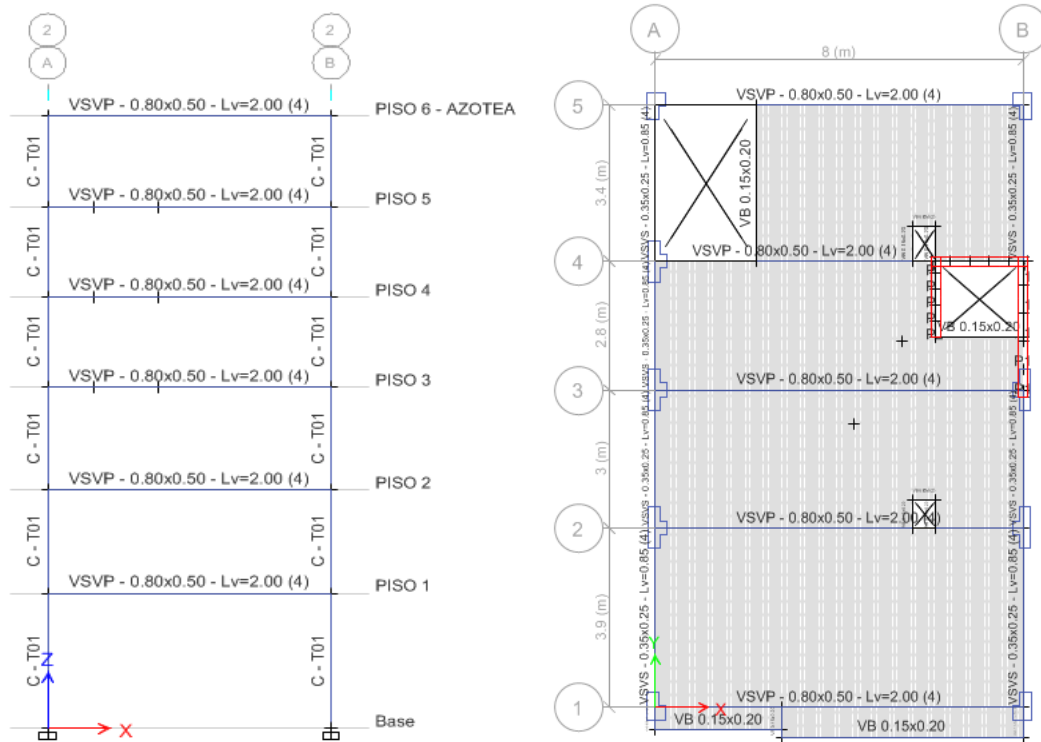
22 Vista en elevación y planta típica de la estructura del pórtico principal 2 - CASO N°04.
